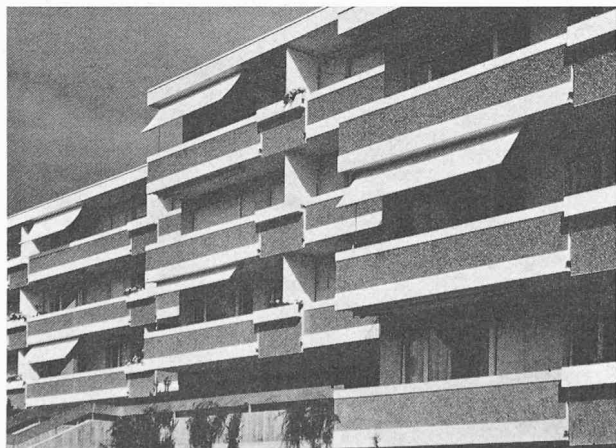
Bâtiment locatif à Bienne/BE. Parapets de balcon en béton lavé et béton apparent combinés, éléments de bordures de toit en béton apparent.
